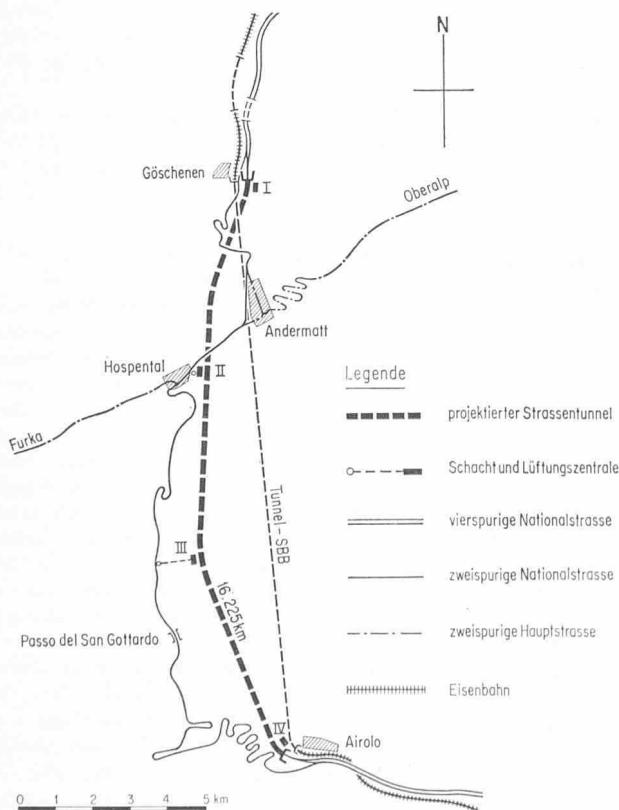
Projekt mit zwei Schächten und Seitenstollen, Lageplan
